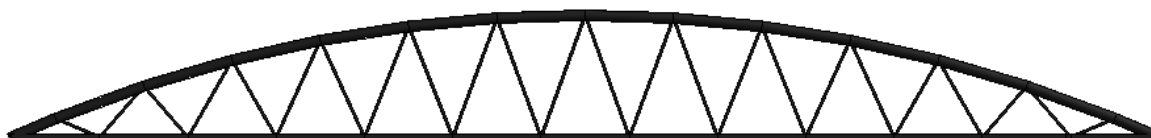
Configuración final de la pasarela de este proyecto con péndolas tipo Nielsen
